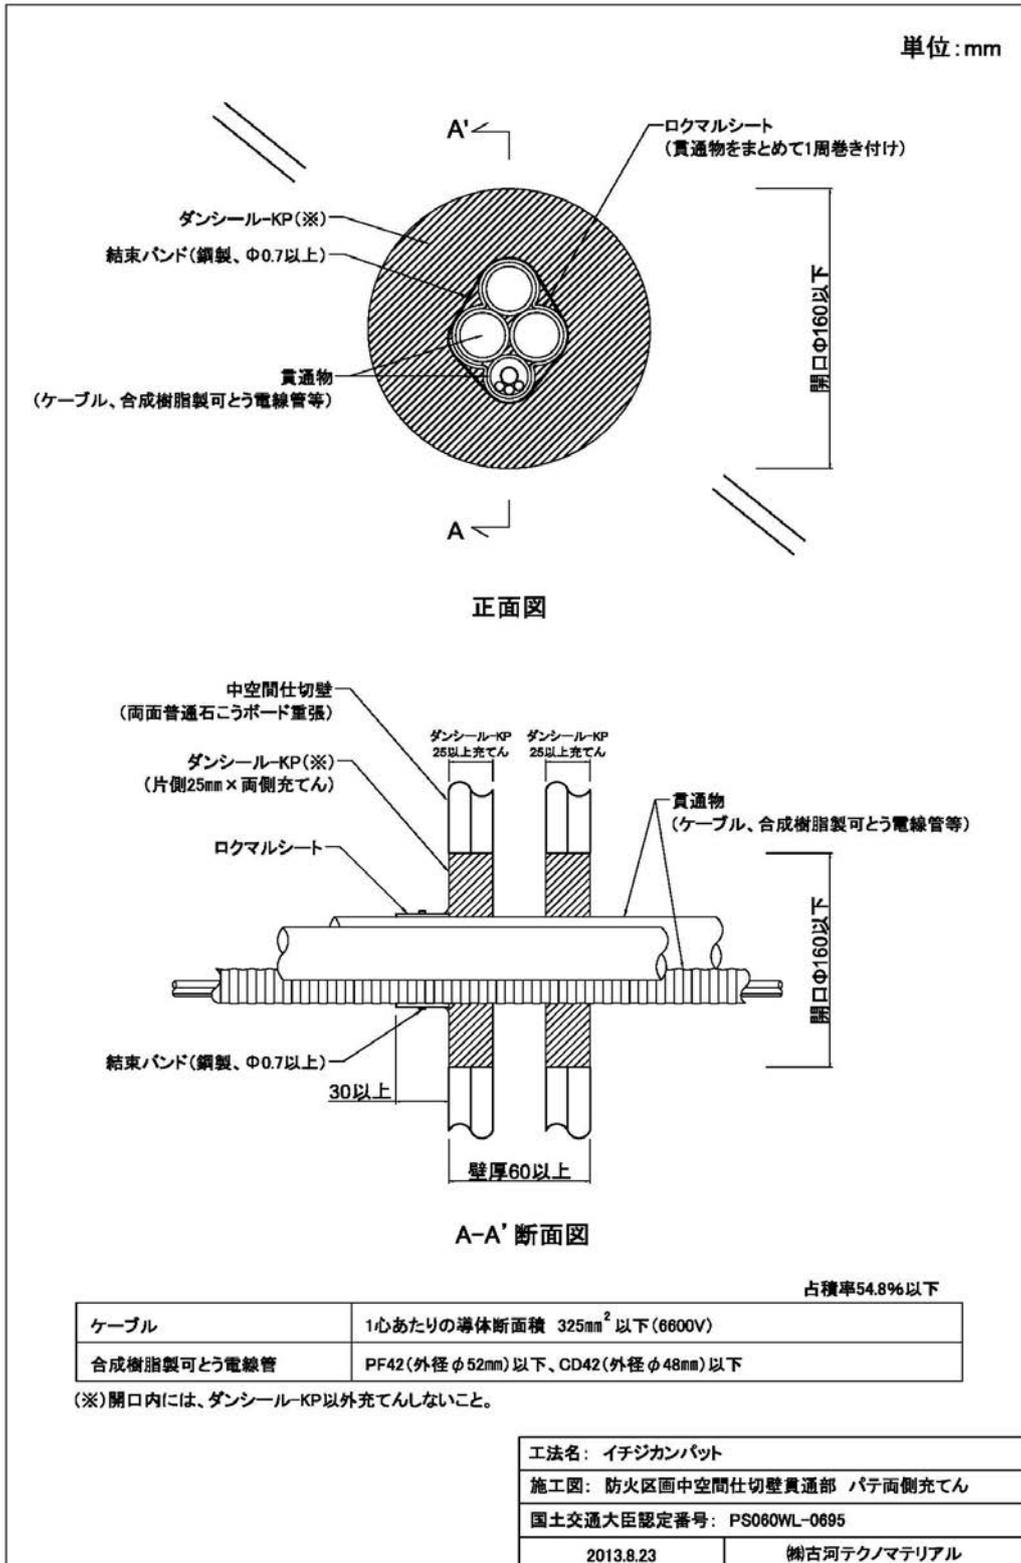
防火区画中空間仕切壁貫通部 パテ両側充てん標準施工図
